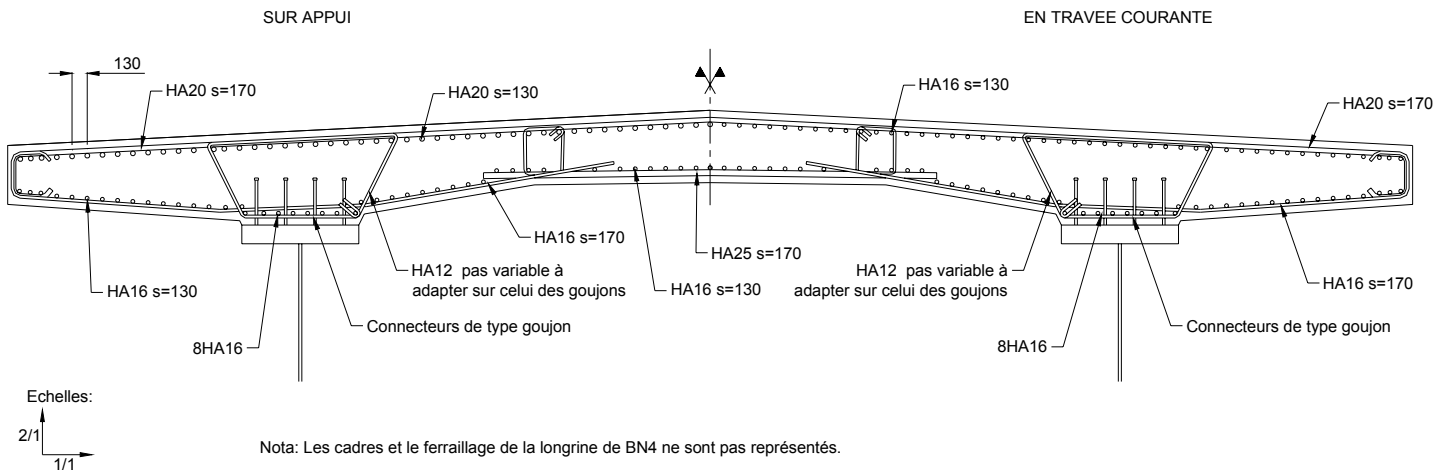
6 : Ferrailage dans une coupe transversale du hourdis
